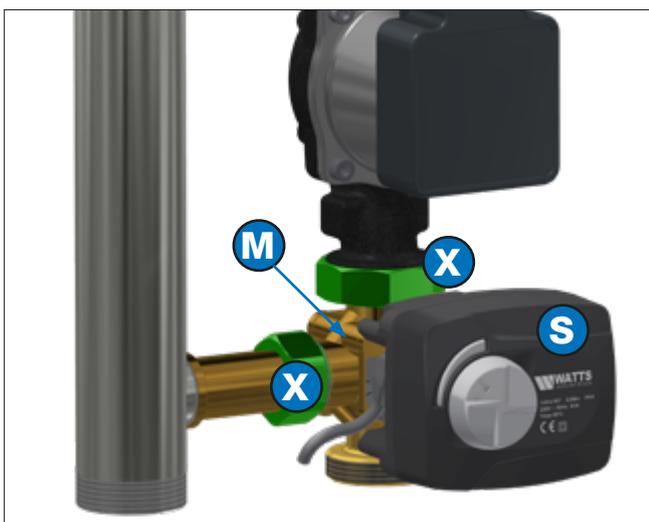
Smontaggio e assemblaggio della valvola miscelatrice a 3 vie
